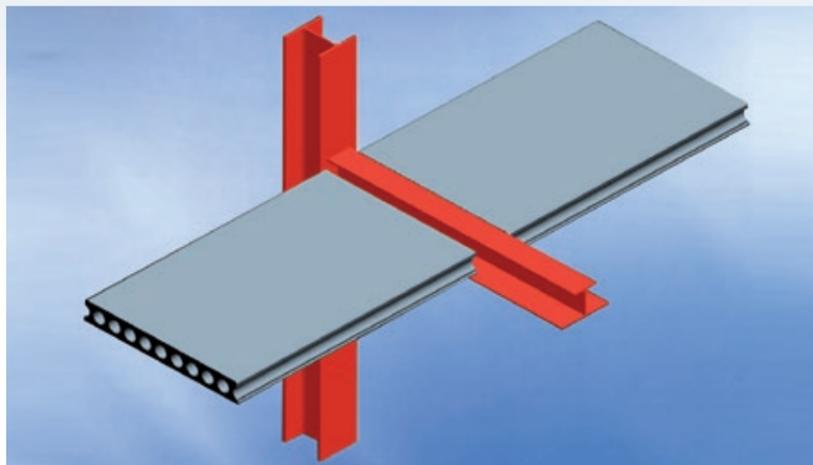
Встроенные балки, поддерживающие сборные железобетонные плиты
